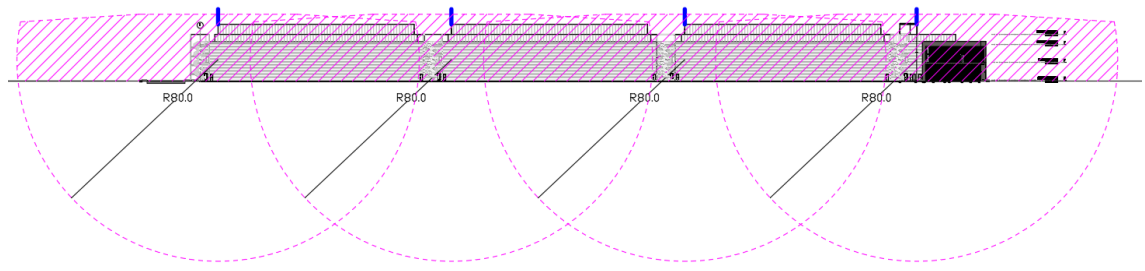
Ilustración 2: Volumen de protección PDC. Vista en alzado
